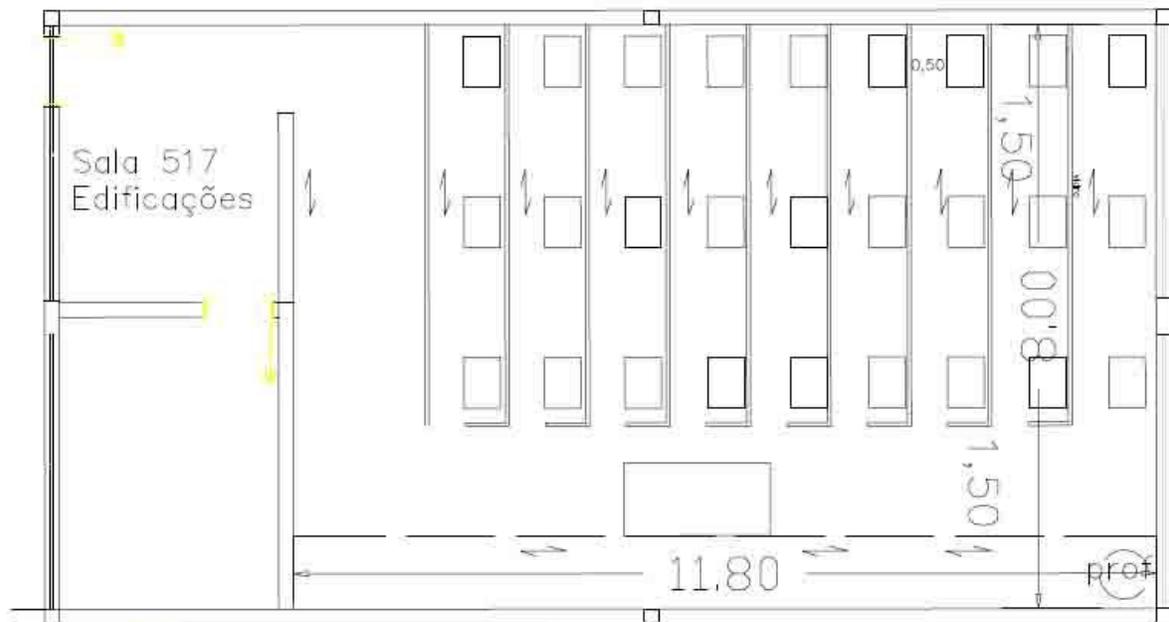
Planta baixa sala 517 - bloco Edificações - Cenário 2
